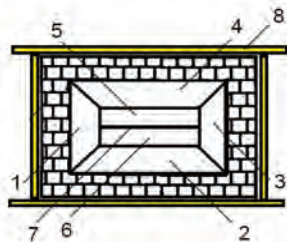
Схема предохранительной разрушающейся конструкции ограждения зданий.
